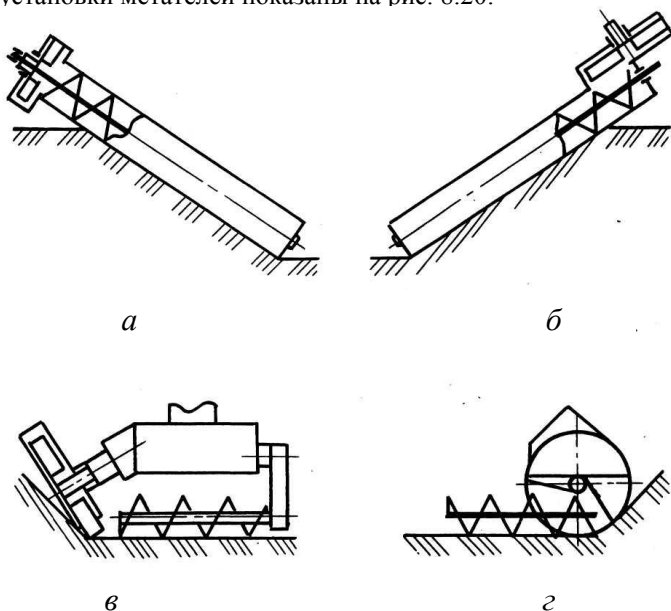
Схемы шнековых рабочих органов: а – крутонаклонный с центральной подачей грунта на метатель; б – крутонаклонный с боковой подачей грунта на метатель; в, г – горизонтальные с боковой подачей грунта на метатель.
